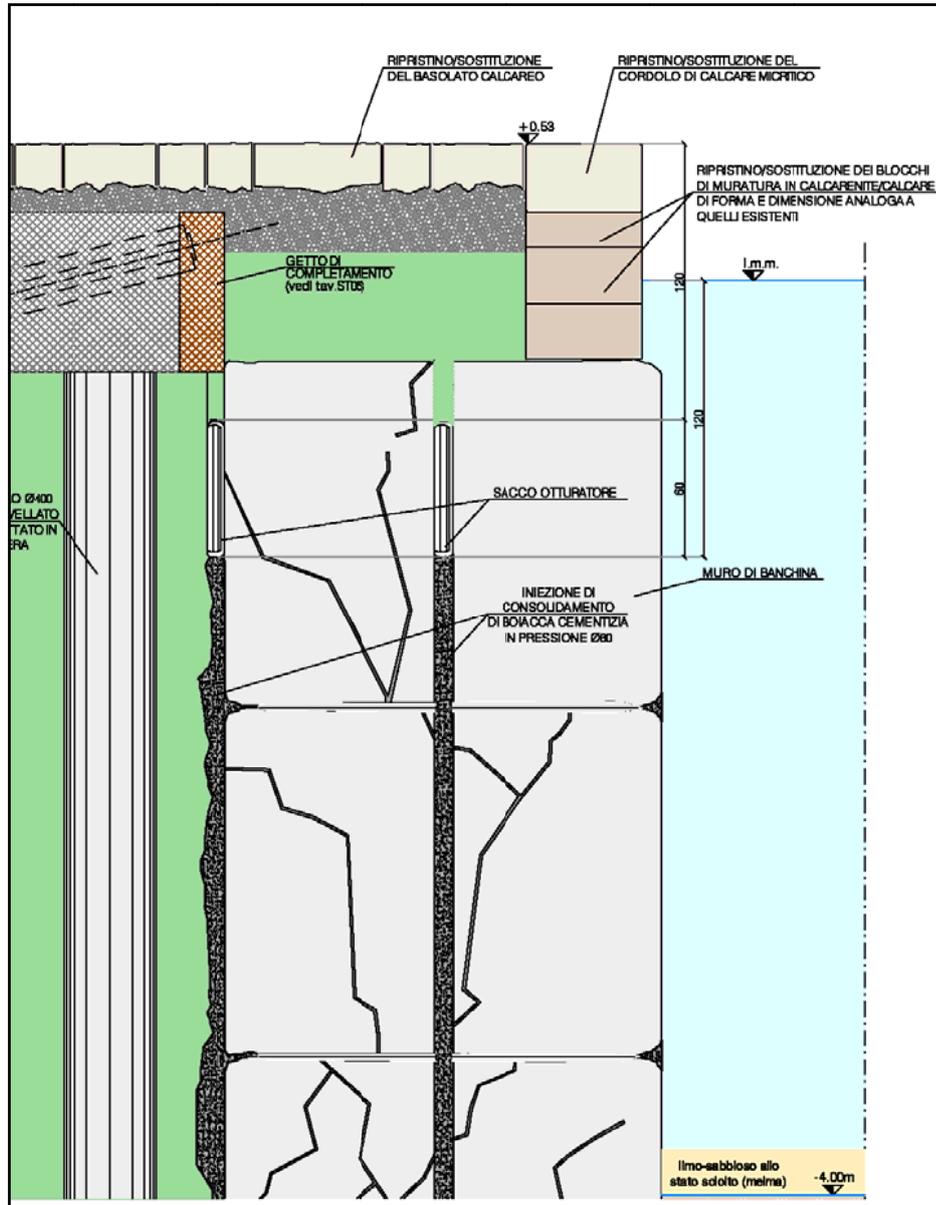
Drenaggio realizzato mediante contenimento delle iniezioni con sacco otturatore – Sezione
